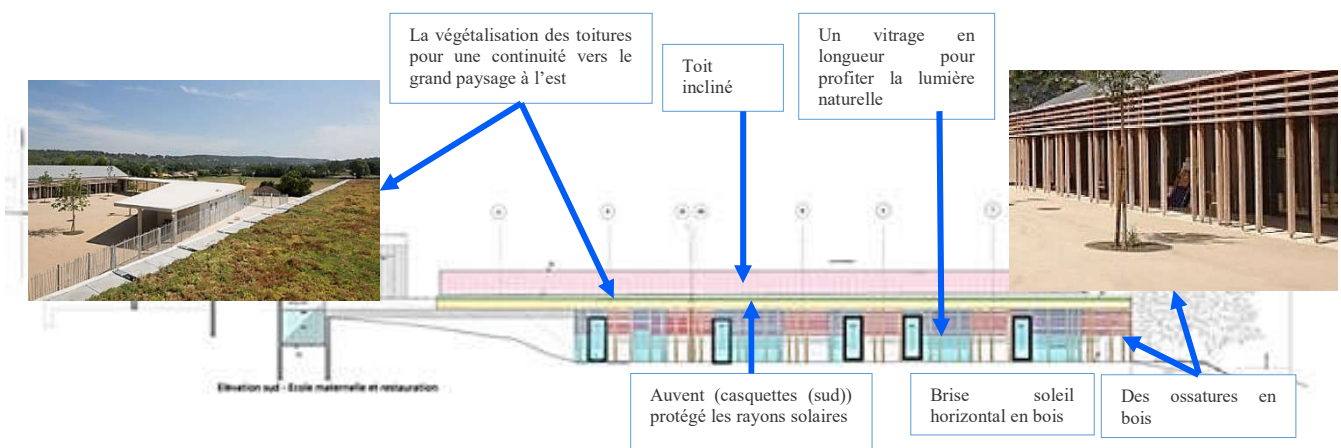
façade Sud-Ecole maternelle. Source : www.construction21.org
